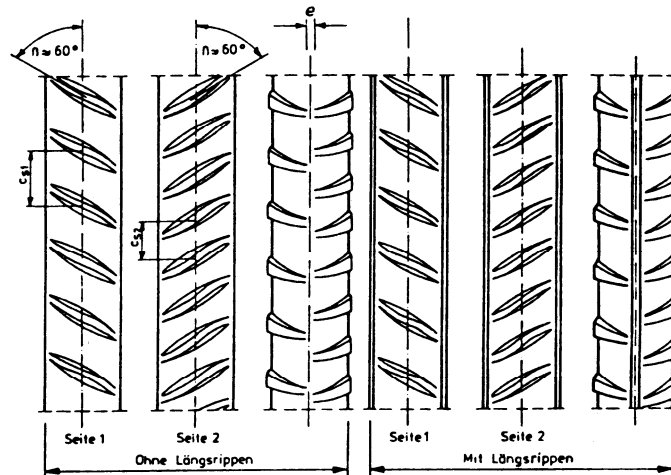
Nicht verwundener Betonstahl BSt 420 S mit und ohne Längsrippen
